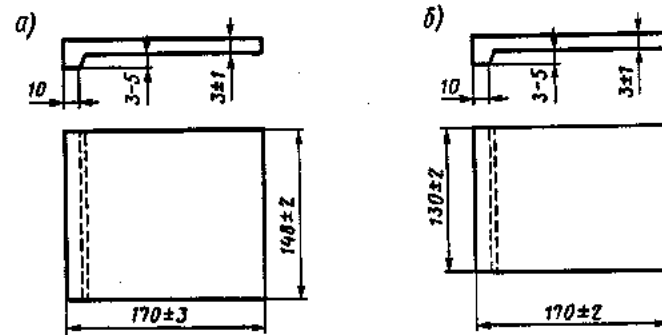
Регулировочные прокладки для железобетонных шпал при раздельном креплении:
